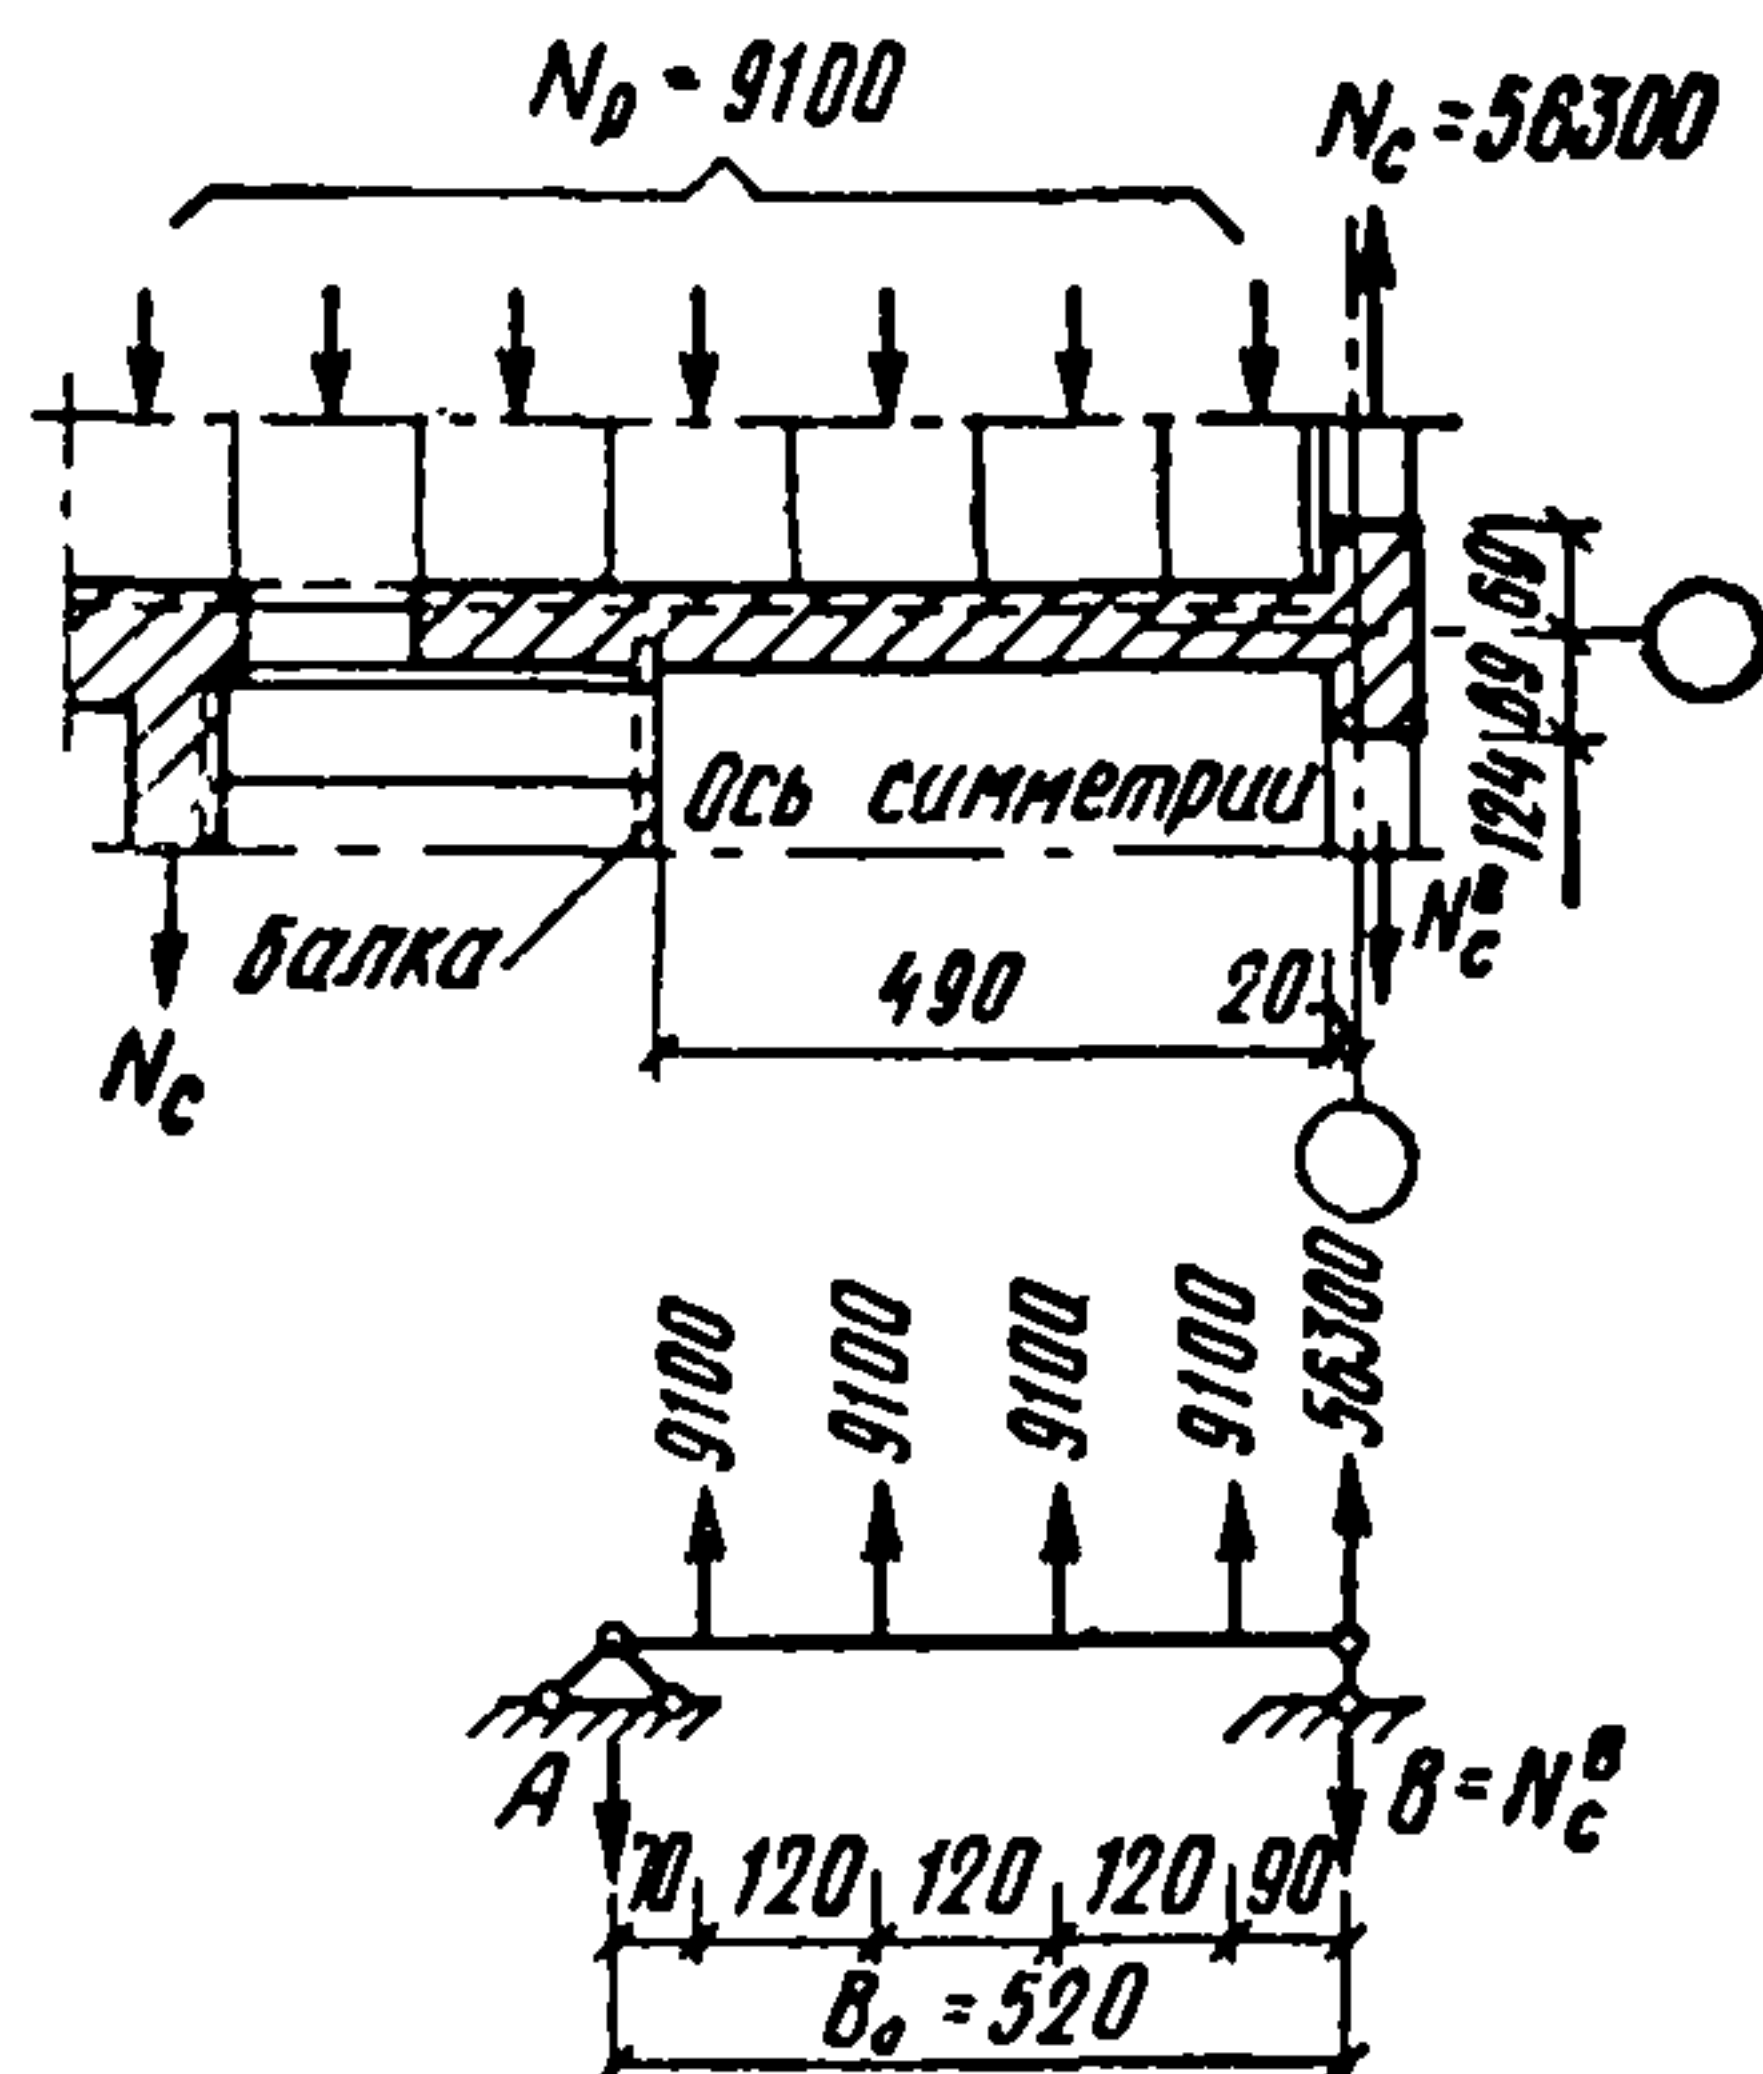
К расчету усилий в наружной стене лестничной клетки
